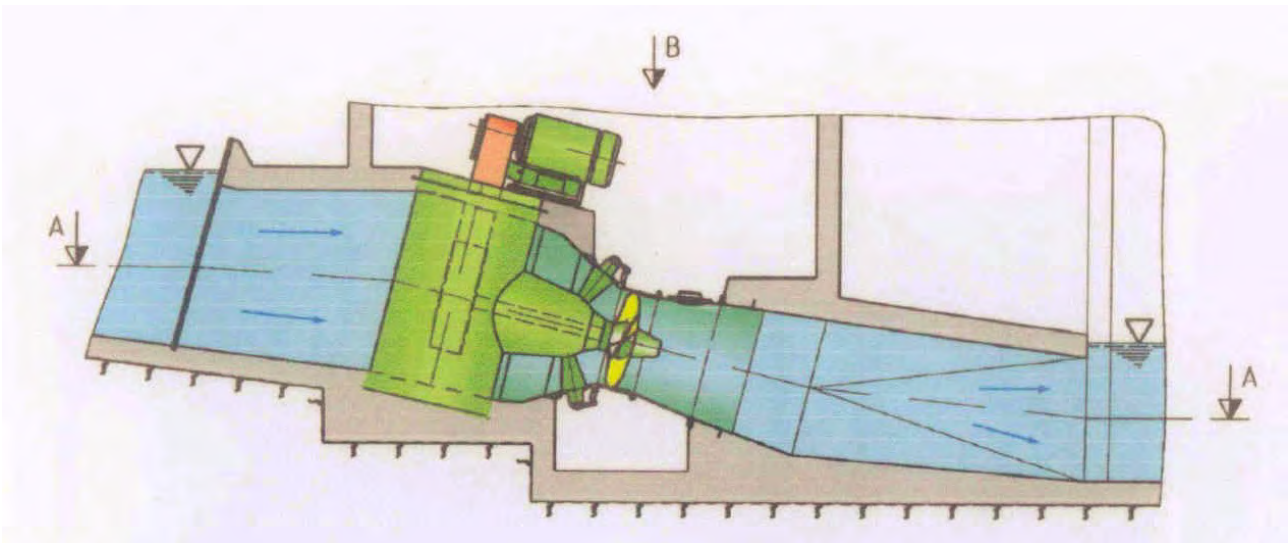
vertikaler Schnitt durch einen möglichen Aufbau eines Laufwasserkraftwerks mit Kaplan-Rohrturbine (gelb)
